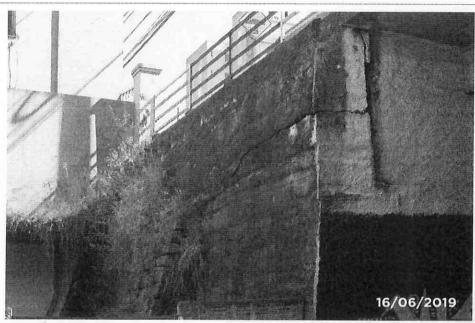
Detalhe da trinca existente no muro de arrimo e vegetação crescendo dentro da trinca.
